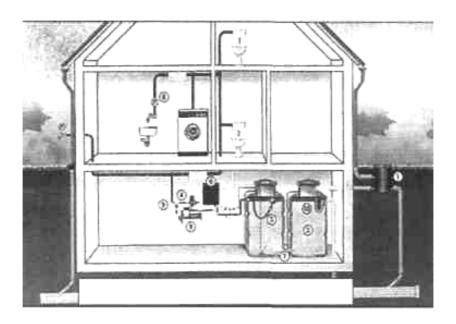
Схема установки с резервуарами в подвале: 1 – автоматический фильтр; 2 – ряд бочек; 3 – поплавок со всасывающей трубой; 4 – насос с регулятором давления; 5 – консоль для установки настенного насоса; 6 – устройство подачи питьевой воды с регулятором, оснащенным поплавковым выключателем; 7 – комплект соединения бочек между собой; 8 – заводские таблички; 9 – вторичный фильтр тонкой очистки; 10 – перелив с сифоном и защитой от грызунов и мелких животных
